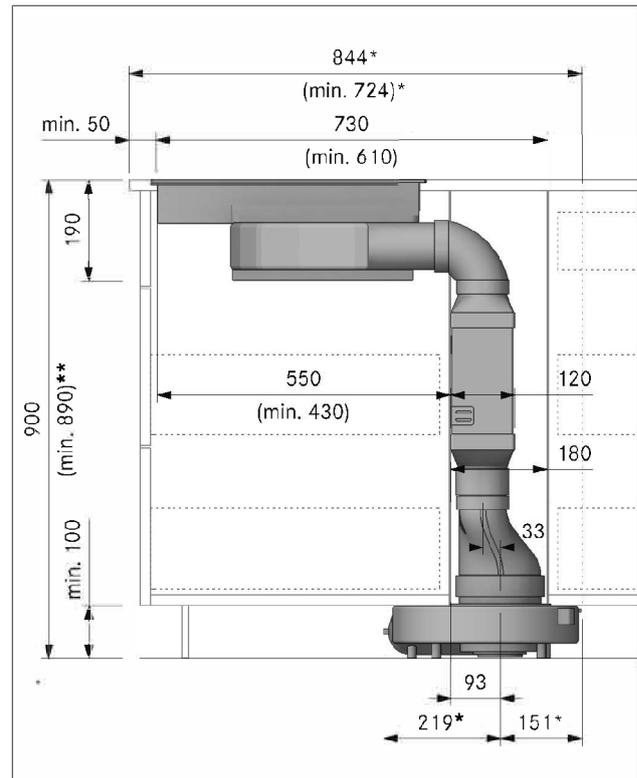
Medidas de montaje del aparato con silenciador plano USDF, empalme de conducto plano EFV y pieza de empalme recta EFRG (isla)
